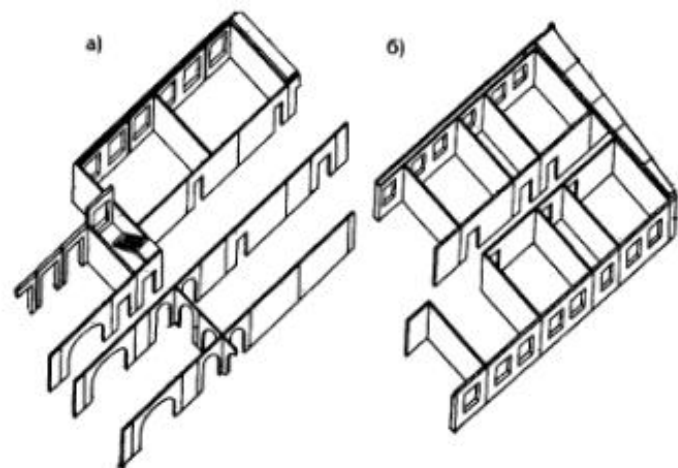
Схемы взаиморасположения несущих конструкций панельных общественных зданий: а - продольно — стенная (по типовому проекту школы); б - поперечно - стенная
